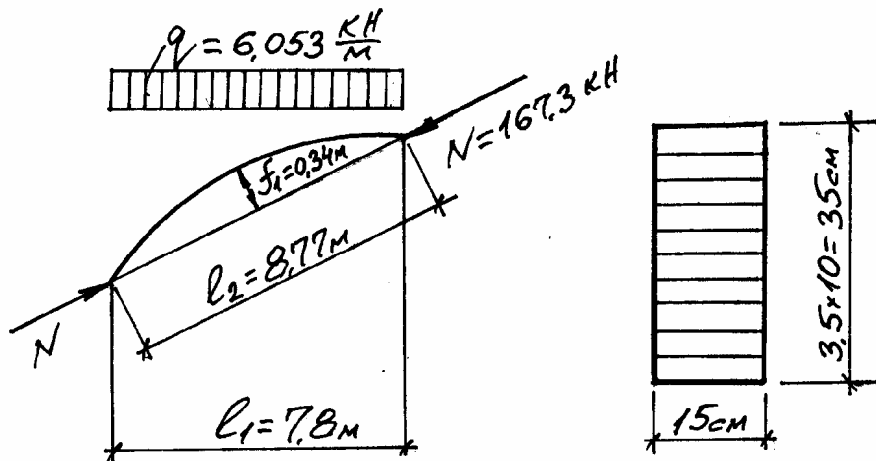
Розрахункова схема і переріз верхнього пояса
